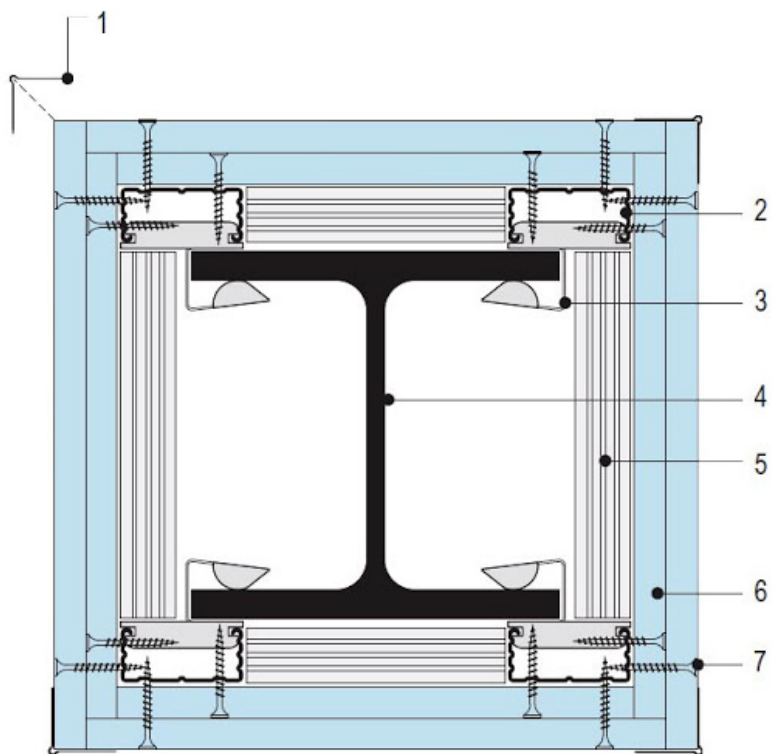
Схема конструктивной огнезащиты балок перекрытия
